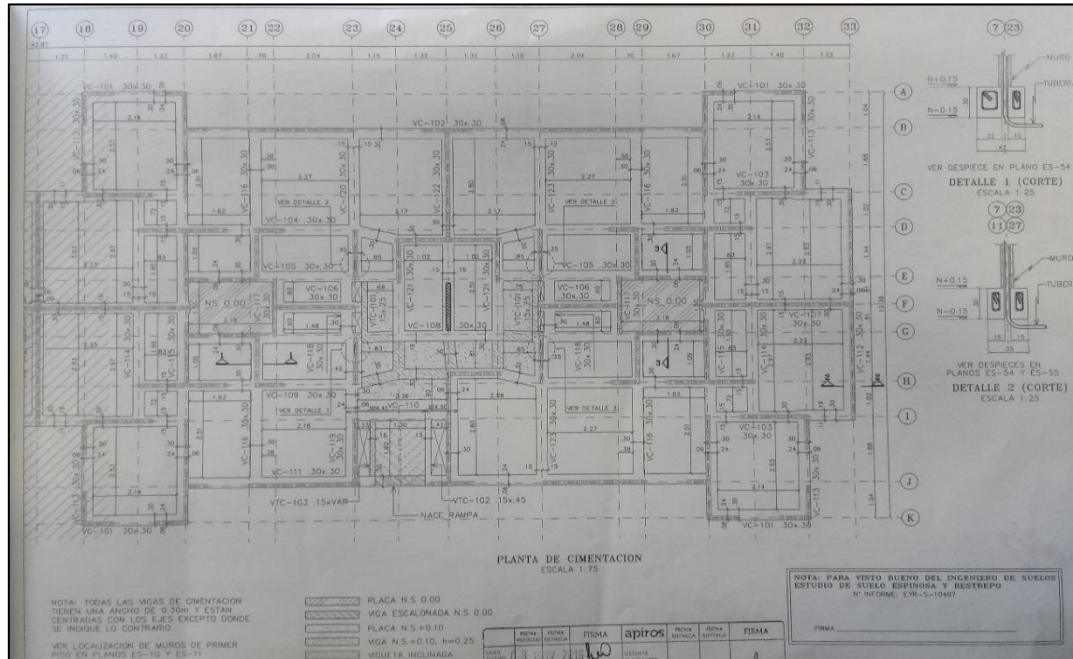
Y 34 PLANOS DE CIMENTACION ES 03 – ES 04
